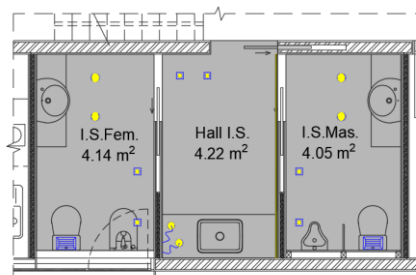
Demonstração de planta de tetos e iluminação. Fonte: Autora.
